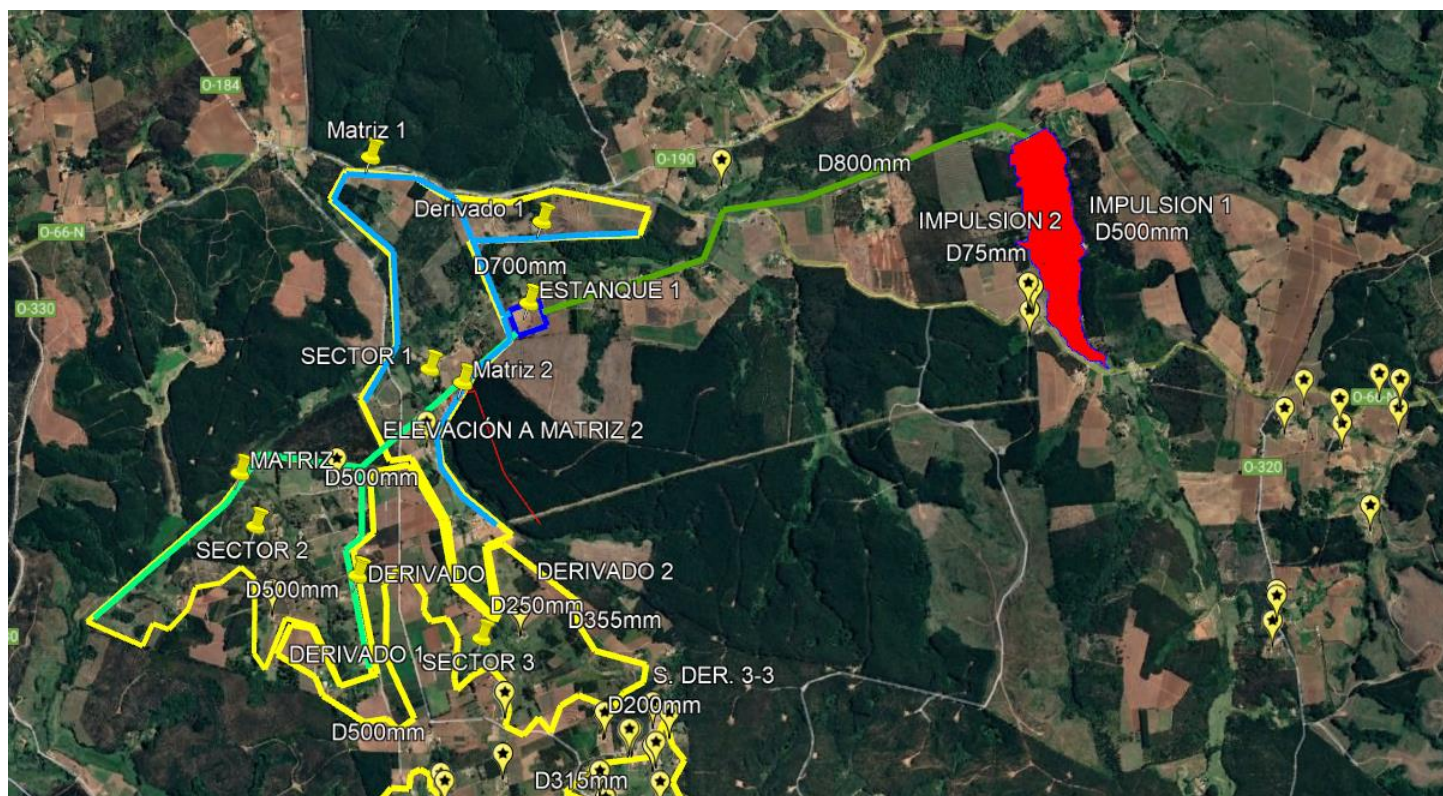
Planta proyecto embalse Rahuil alternativo
